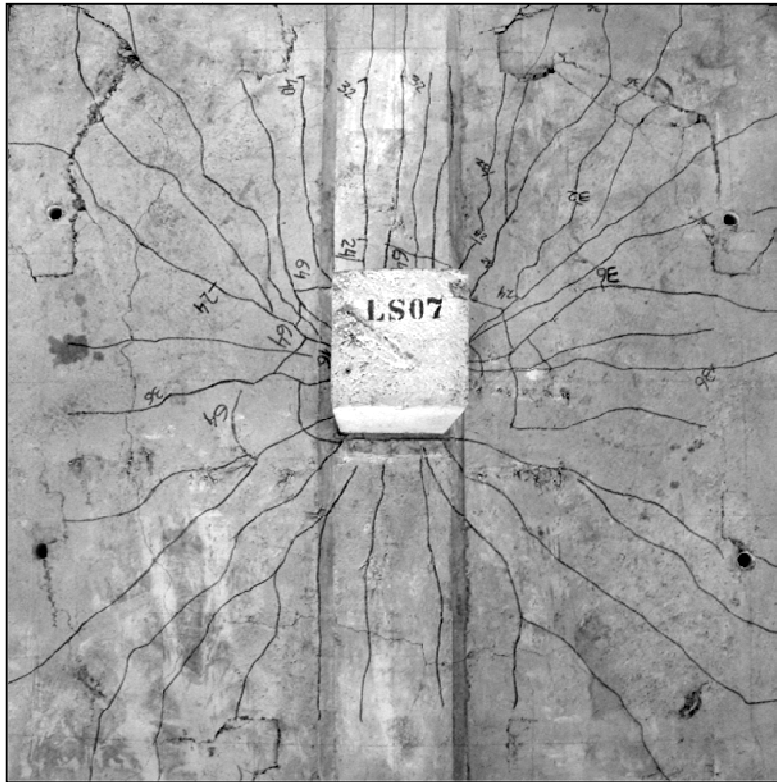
Mapa de fissuração da laje LS07
